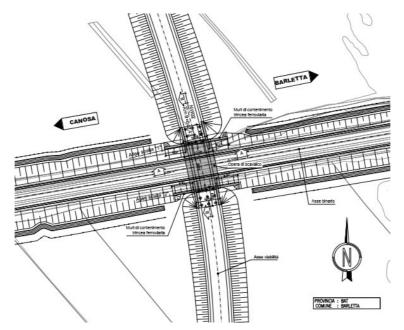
Cavalcaferrovia NW02 – Planimetria
